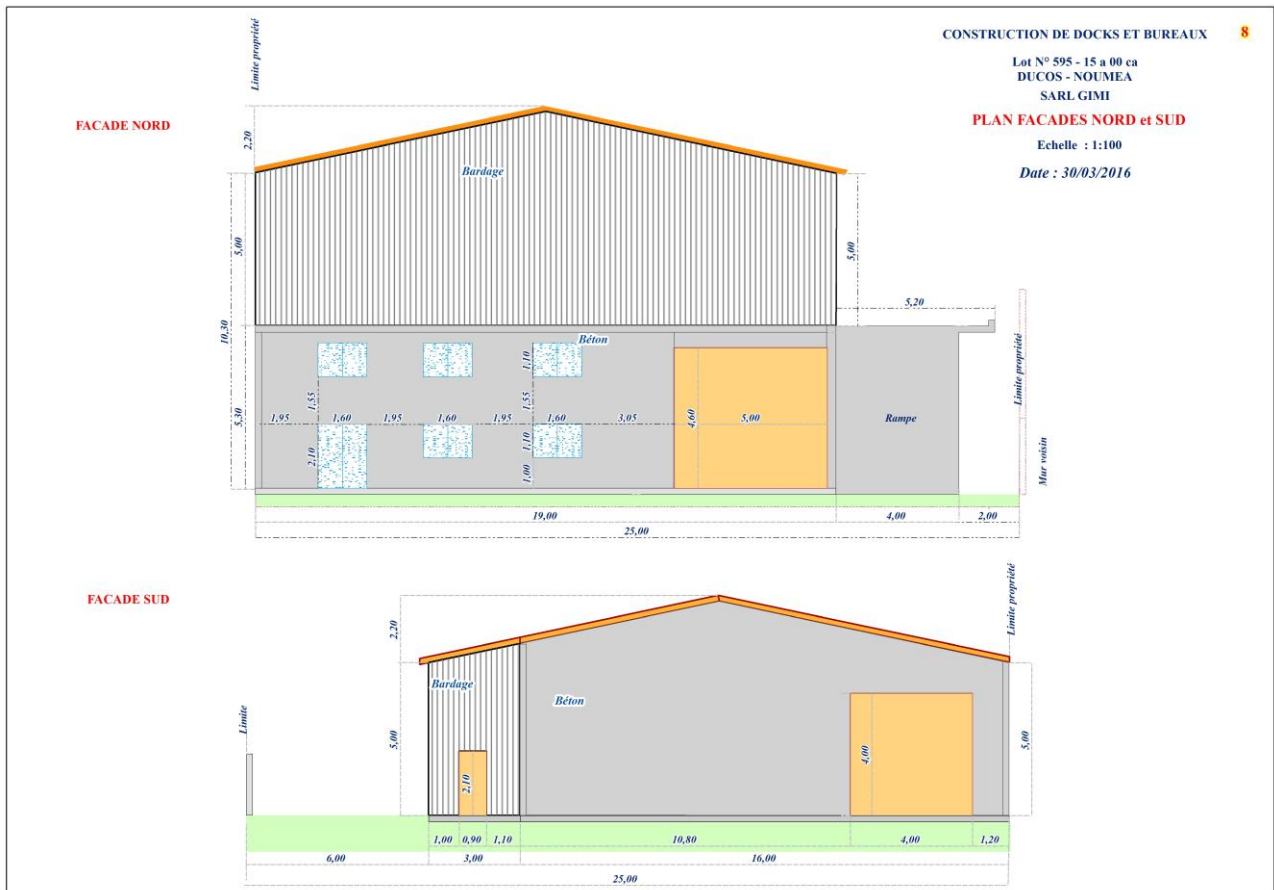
Coupes et plans façades du dock (RECY'GEM)
